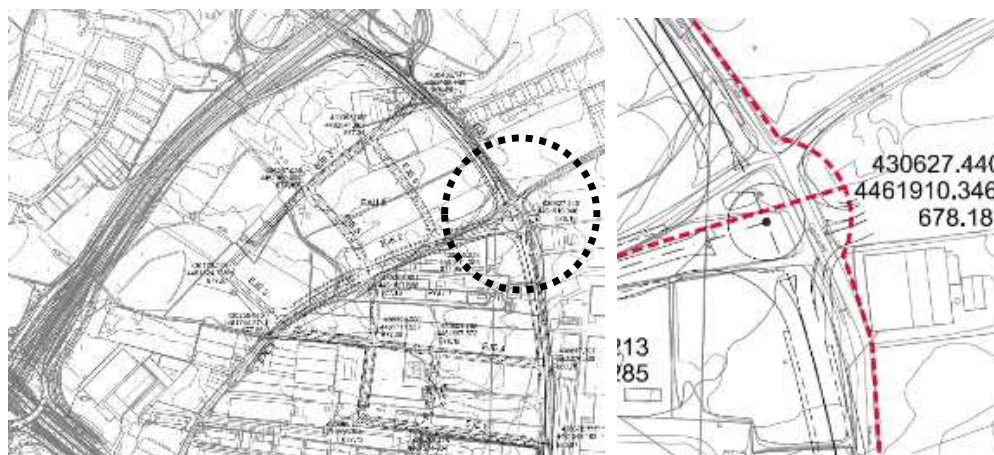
Ordenación del Plan de Sectorización del PAU-7/PAU-8
